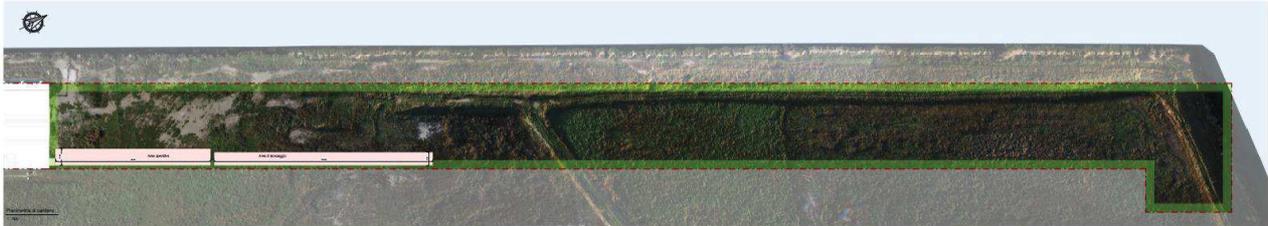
Planimetria con localizzazione delle aree operative e di stoccaggio.
